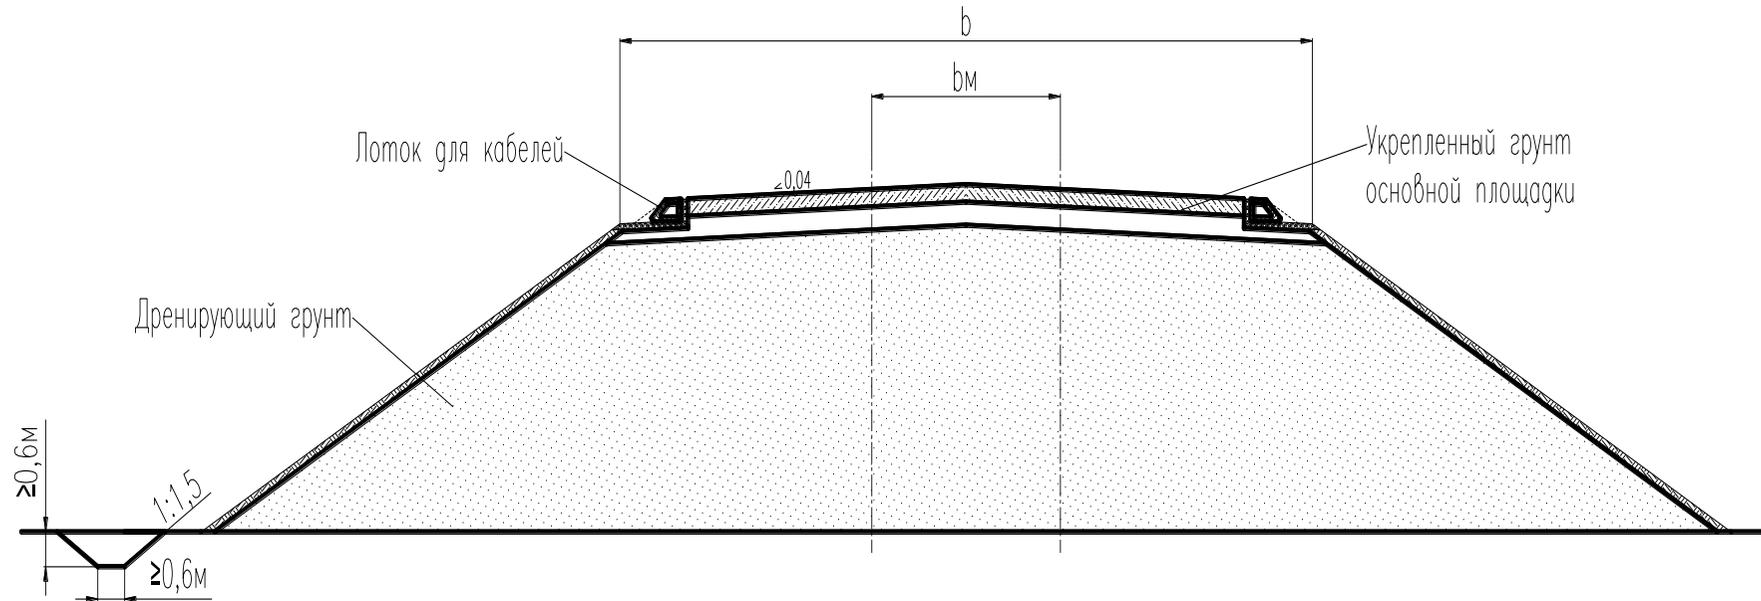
Схема укрепления грунта основной площадки земляного полотна на переходном участке перед пролетными строениями
